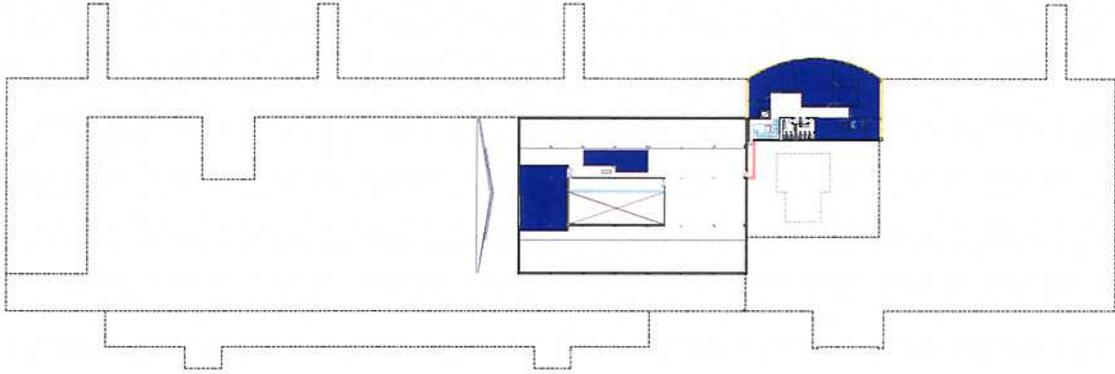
Instalaciones actuales del Edificio Terminal de Pasajeros. Entreplanta (2006)
